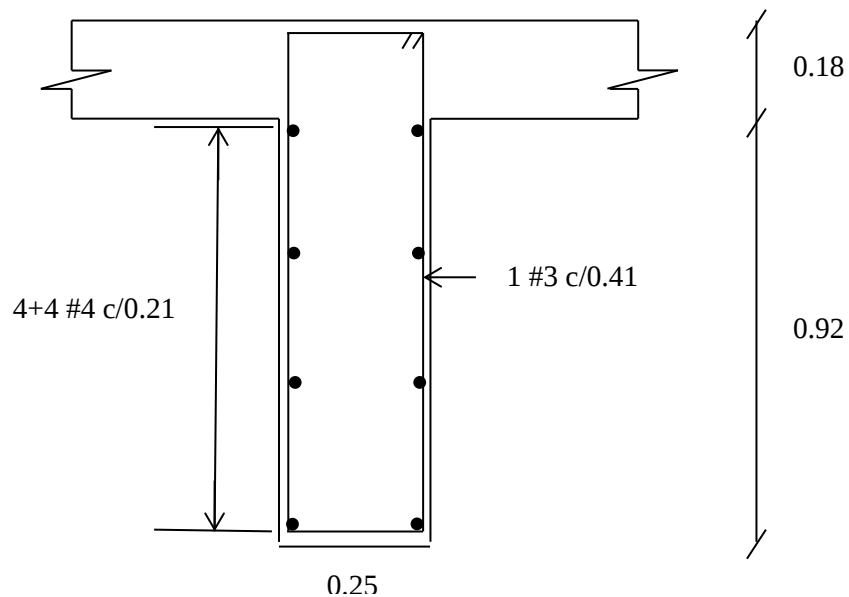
Detalle de armado de la viga diafragma, vista transversal del diafragma.
